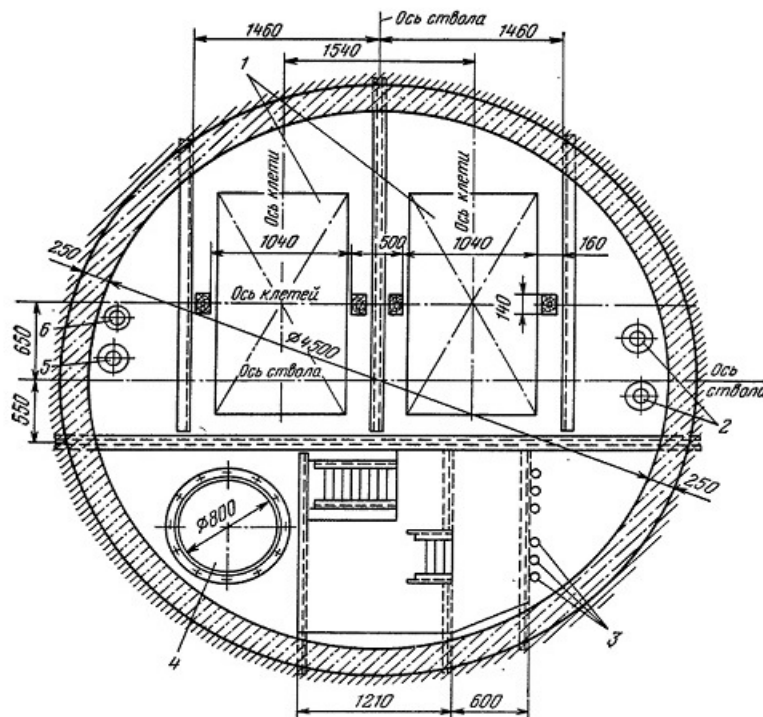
Типовое круглое сечение шахтного ствола: 1 – шахтные клетки; 2 – трубы для водоотлива; 3 – электрические кабели; 4 – вентиляционный канал; 5 – труба подачи сжатого воздуха; 6 – трубопровод водоснабжения.
